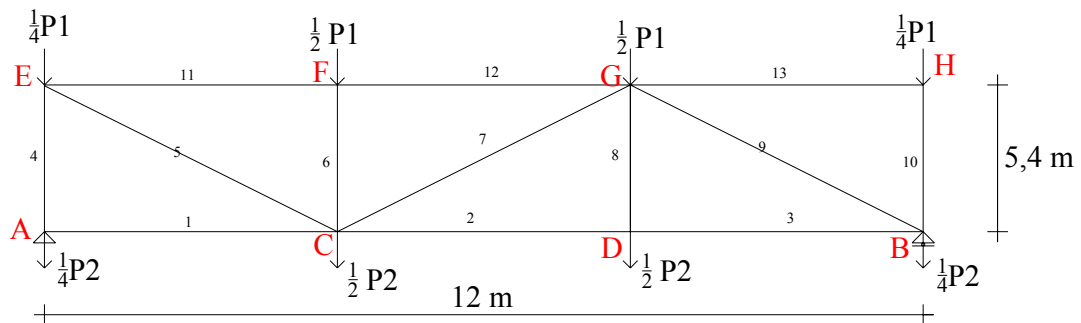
Penyebaran Beban Angin Pada Ikatan Angin Primer Bawah
